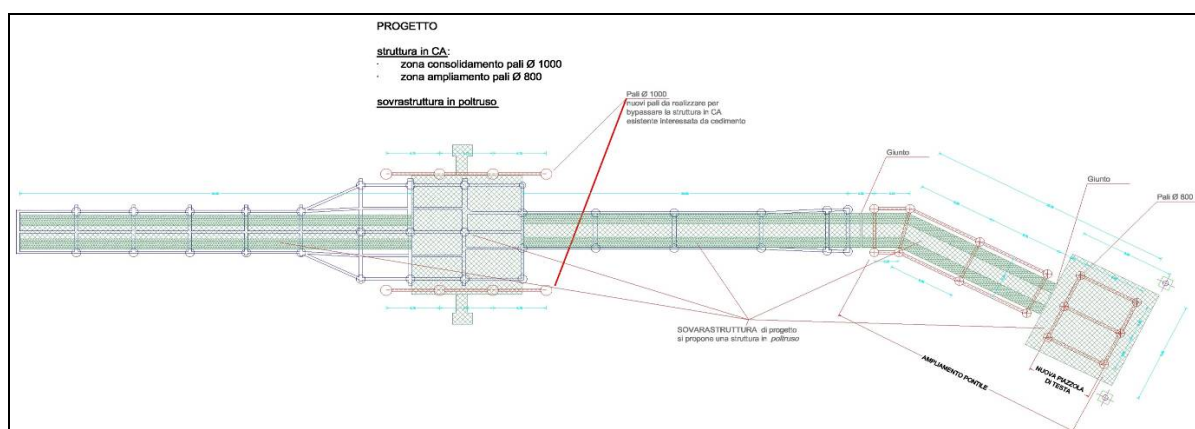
Progetto della nuova sovrastruttura e del prolungamento del pontile
